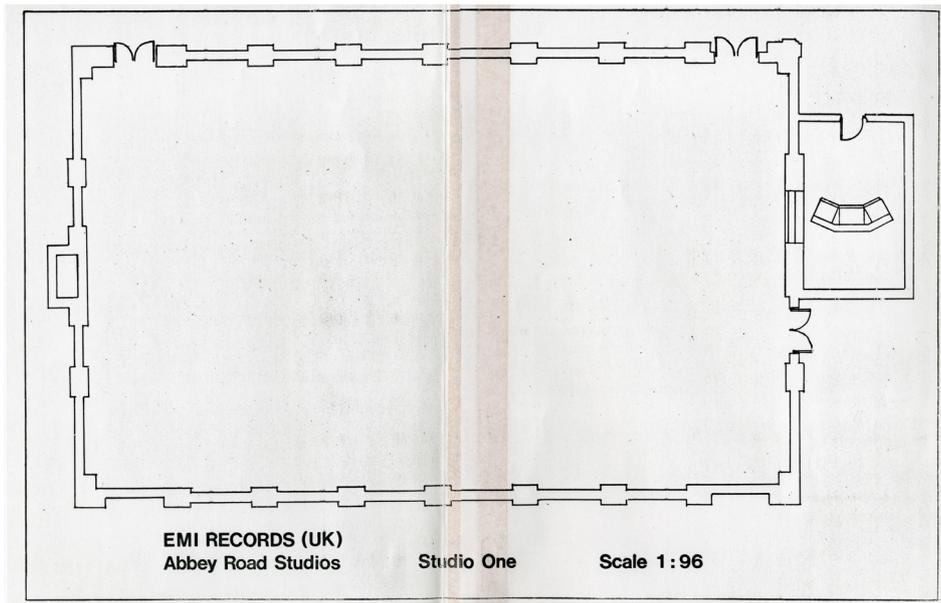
Planta Studio One. Abbey Road (EMI). 1929
